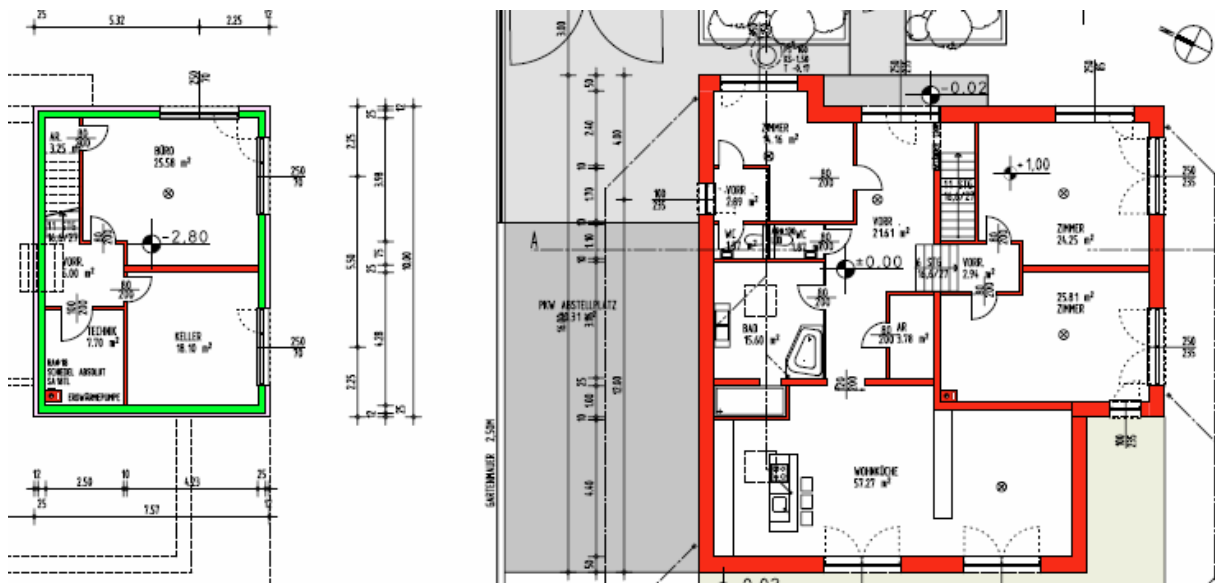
Grundriss von Keller (links) und Erdgeschoss (rechts) (Quelle: Einreichplan)
